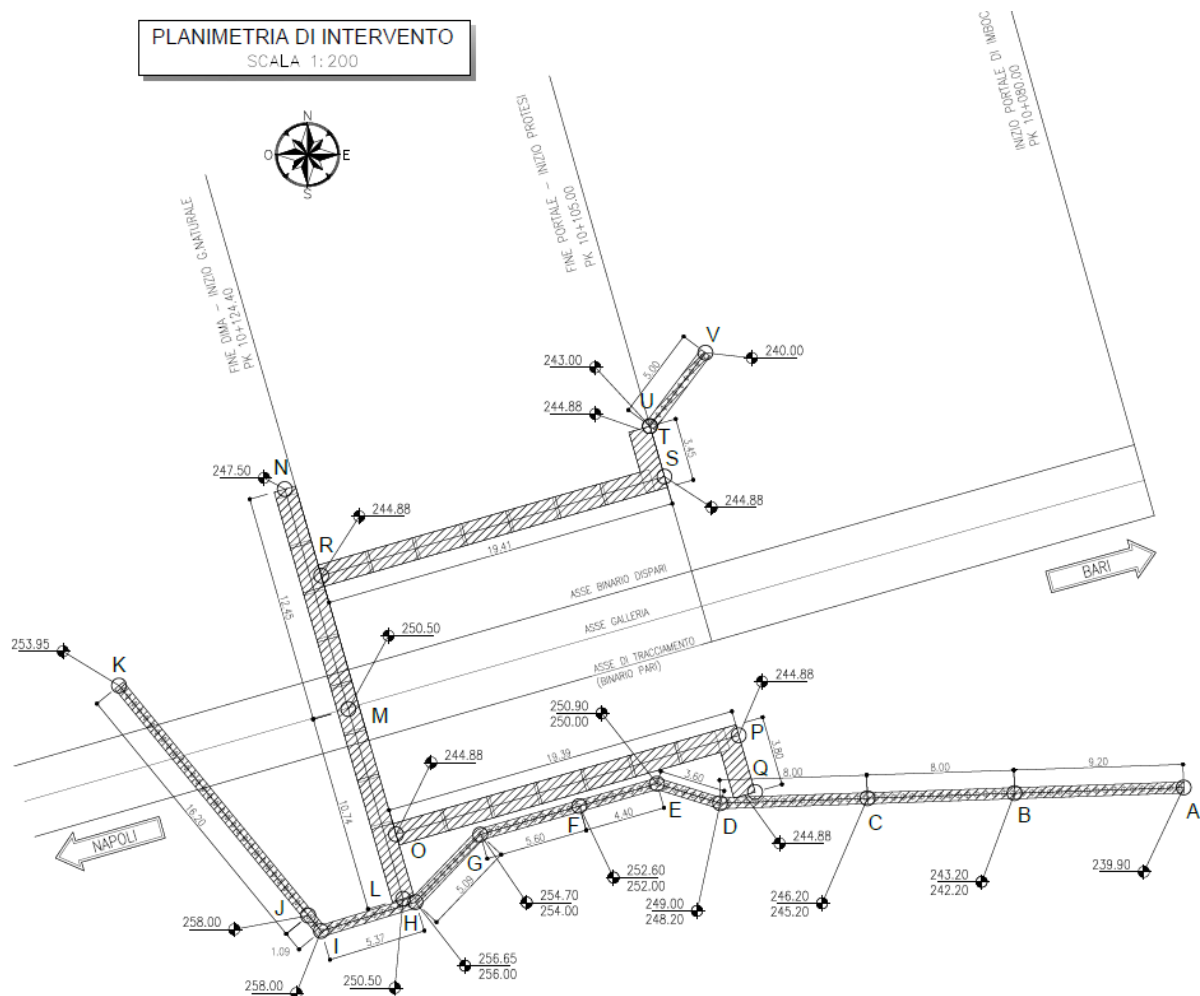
Planimetria riiepilogativa delle strutture di sostegno
